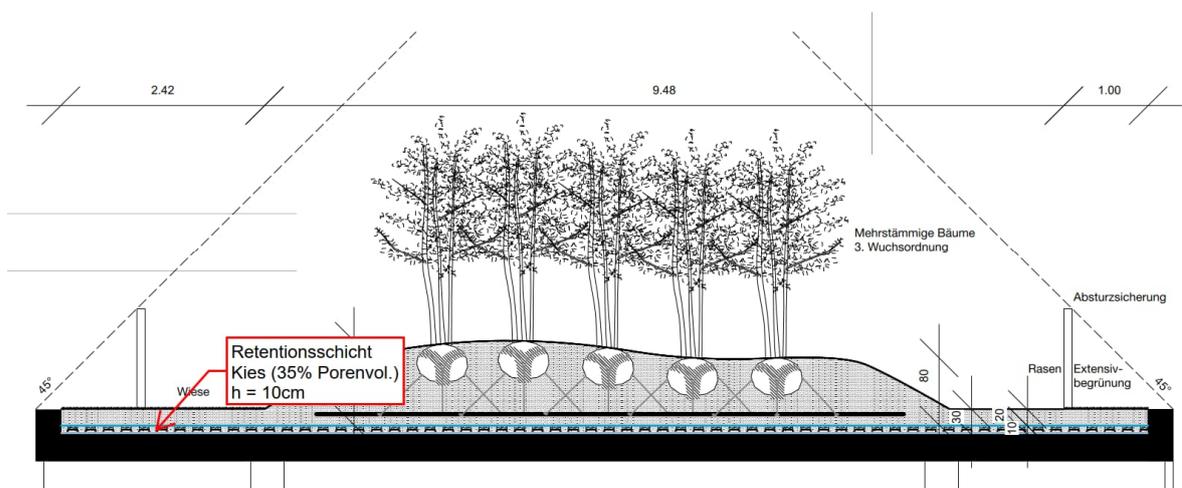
VORABZUG Regelschnitt Dachgeschoss Baumpflanzung mit Modellierung, bearbeitet (Vogt, 2023)
